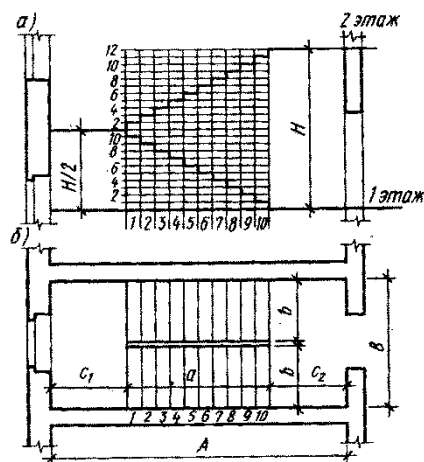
Схема разбивки лестницы: a – в разрезе, b – в плане
